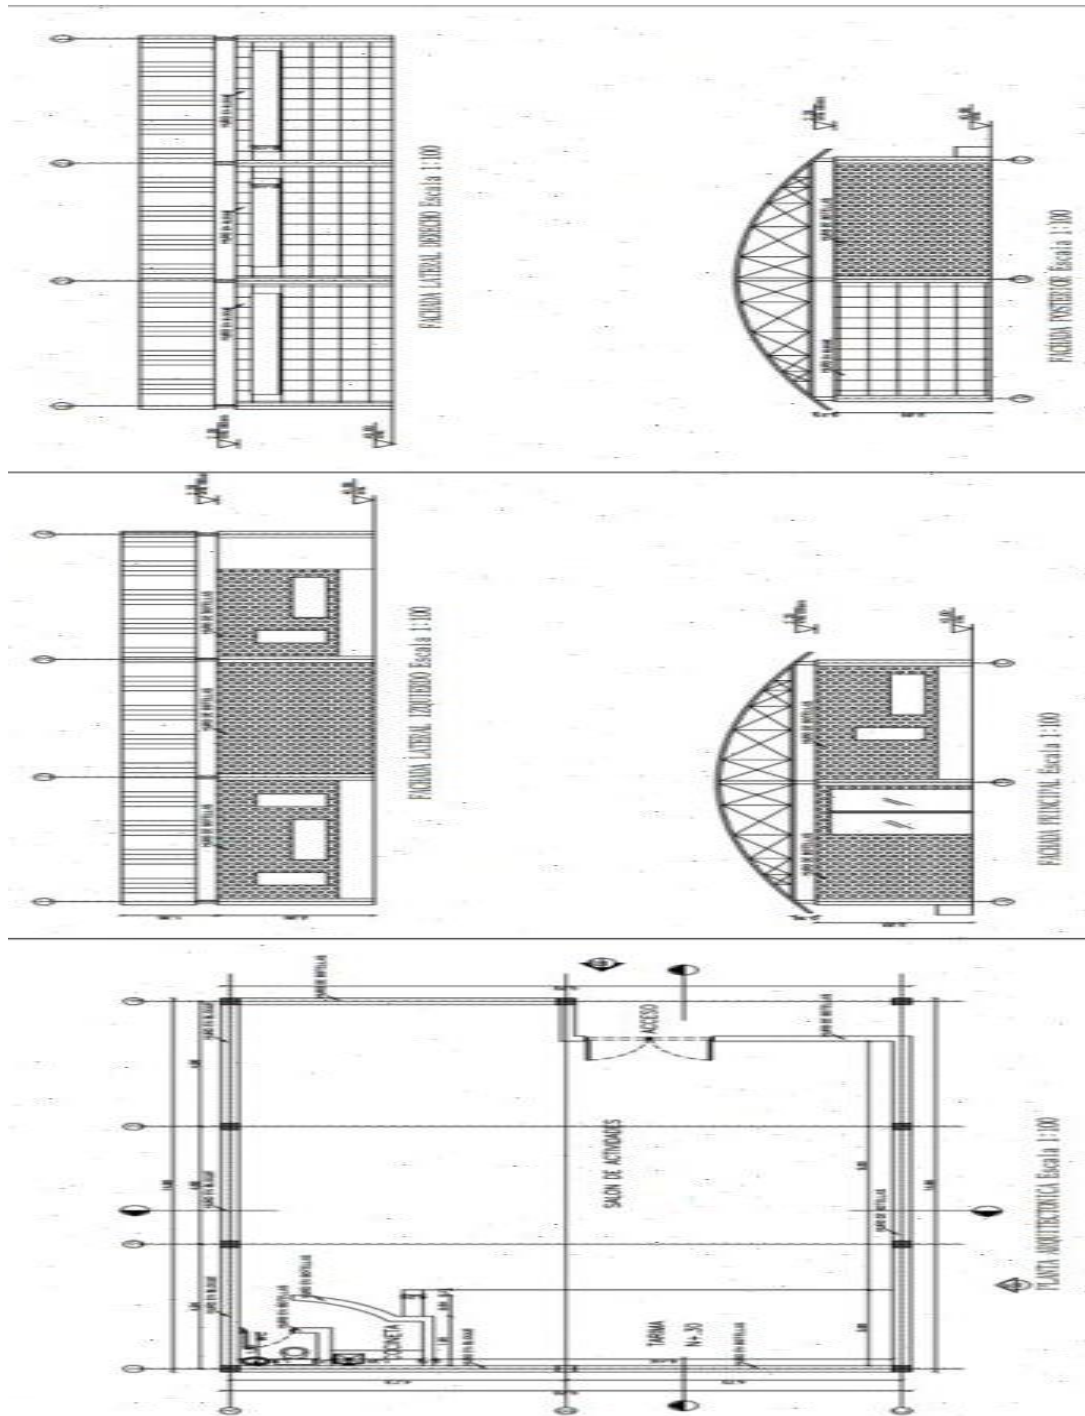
Planta de plano arquitectónico proyecto “Verbenal Sueña”
